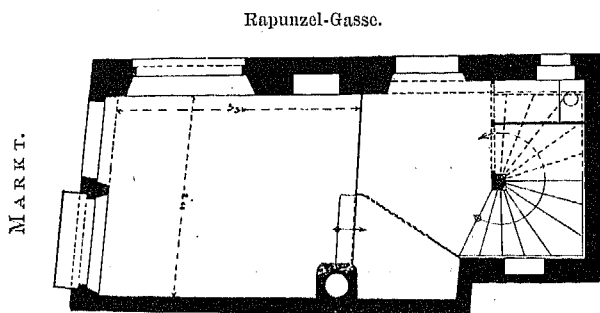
Kleiner Engel; Grundriss des Erdgeschosses.
